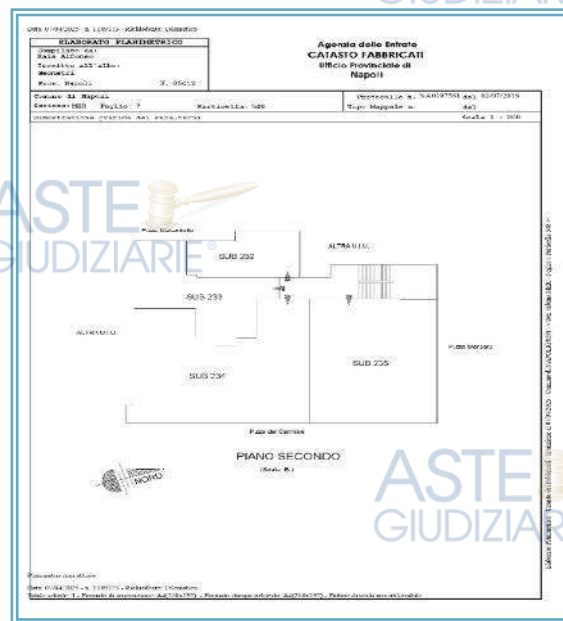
Elaborato planimetrico – Sez MER Foglio 7 particella 548
